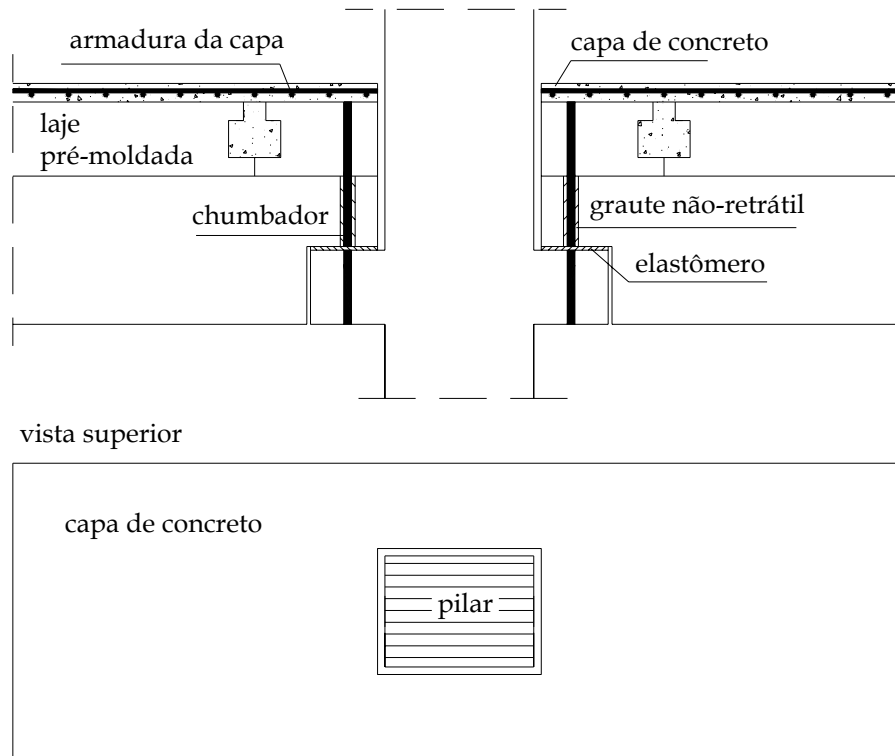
Ligação viga-pilar utilizada correntemente.
